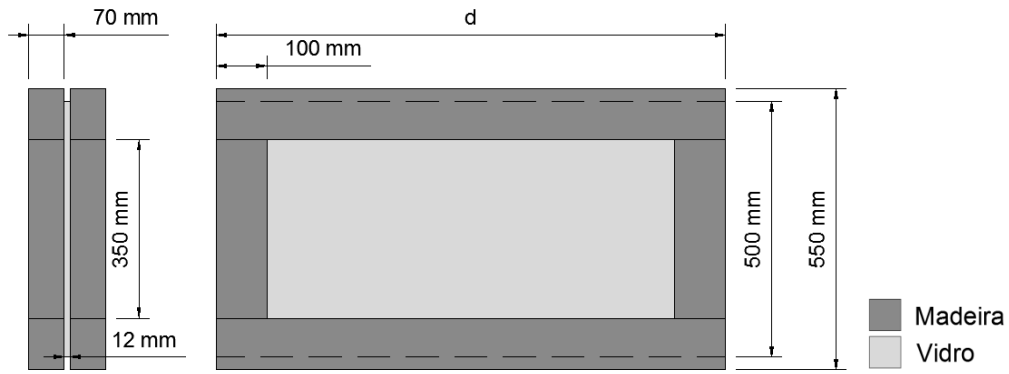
Geometria das vigas da Fase 2, com prumos verticais.
